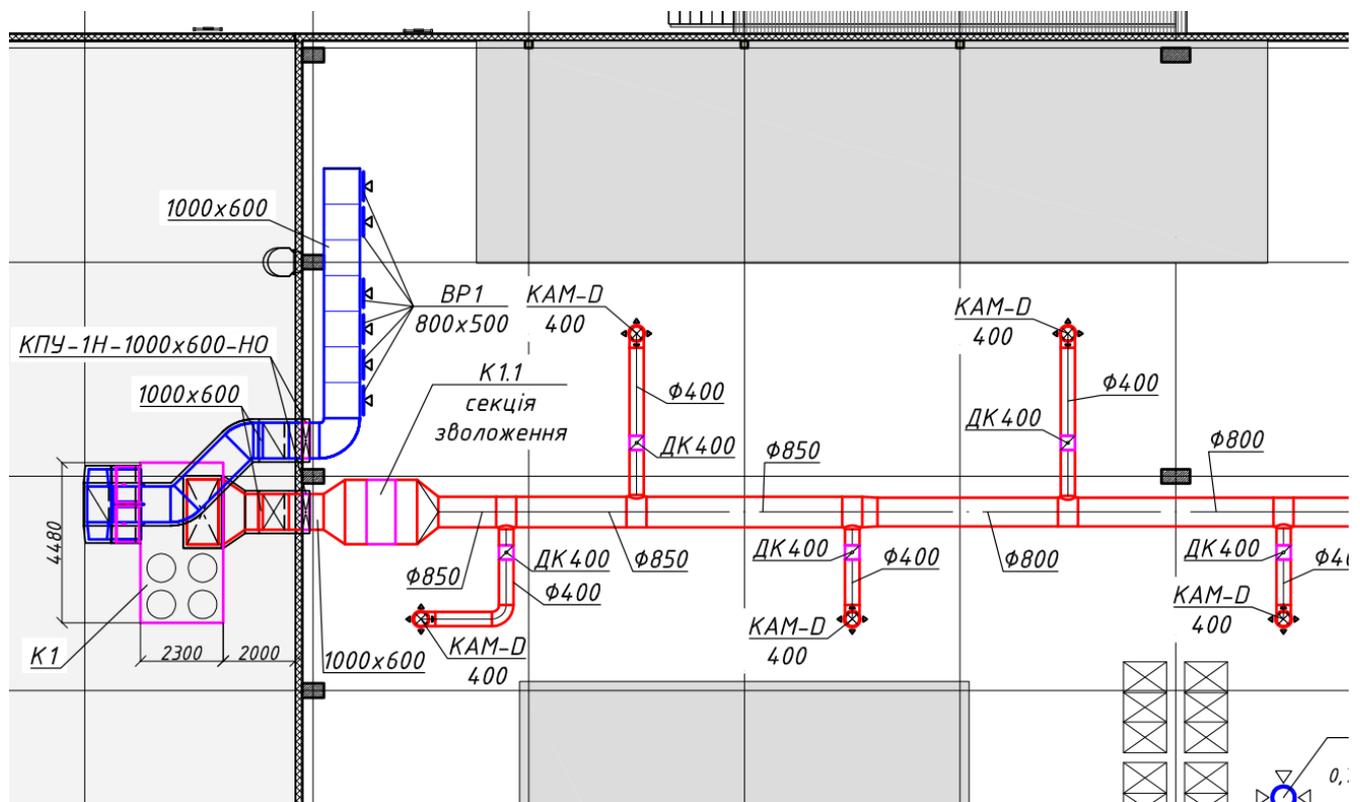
Фрагмент схеми вентиляції ПВ-1 для аеродинамічного розрахунку
